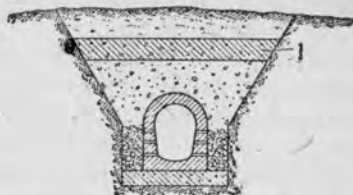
Дренаж из бетона и каменной кладки с засыпкой из гравия.
